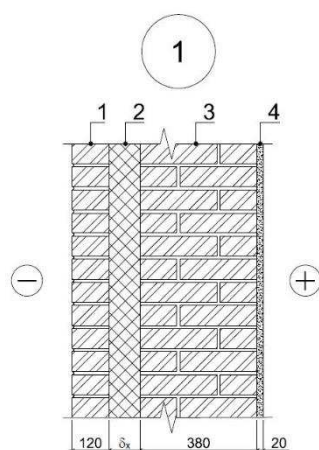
Вариант 1 конструкции наружной стены
